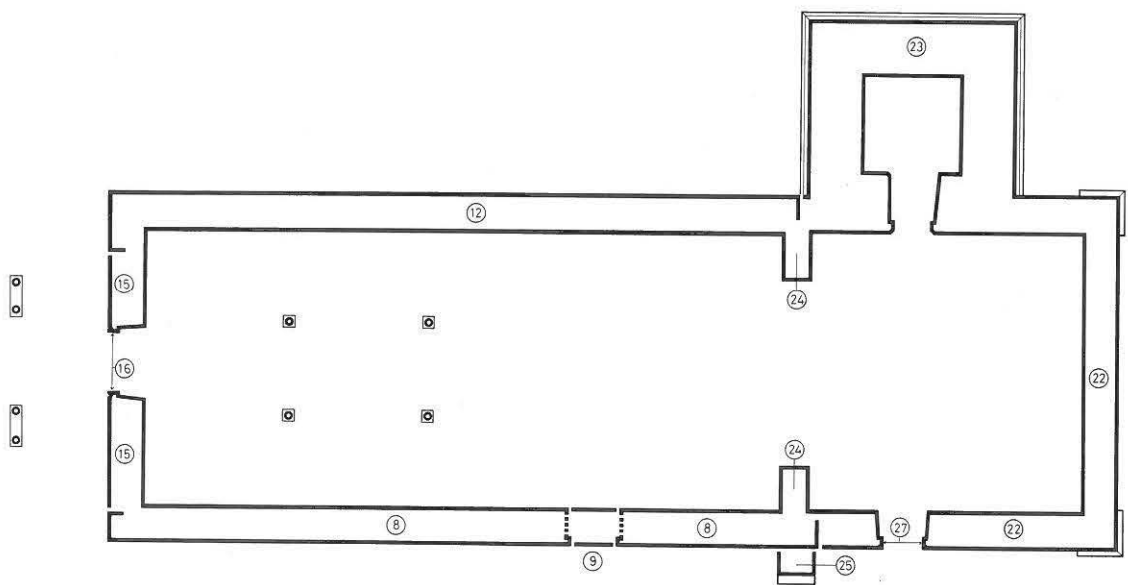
Plan mit den jüngeren Strukturen der Kirche. M. 1:200.
